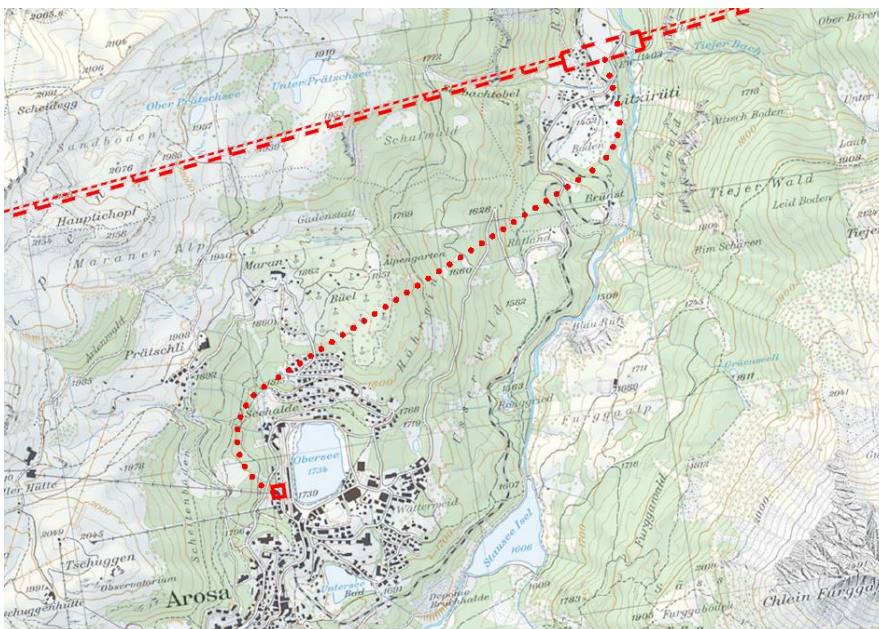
3: Ausschnitt Situationsplan, Bereich Arosa
